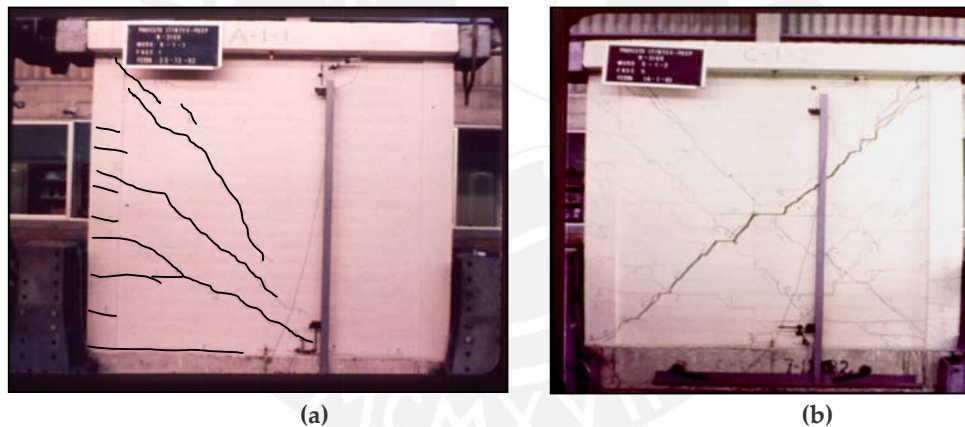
(a) Falla por flexión; (b) Falla por corte en muros de albañilería ante cargas paralelas a su plano (Fotos: San Bartolomé)
